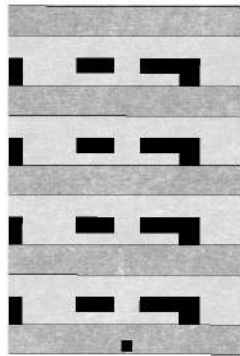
Pianta piano tipo (Fonte: elaborazione dell'autore).
